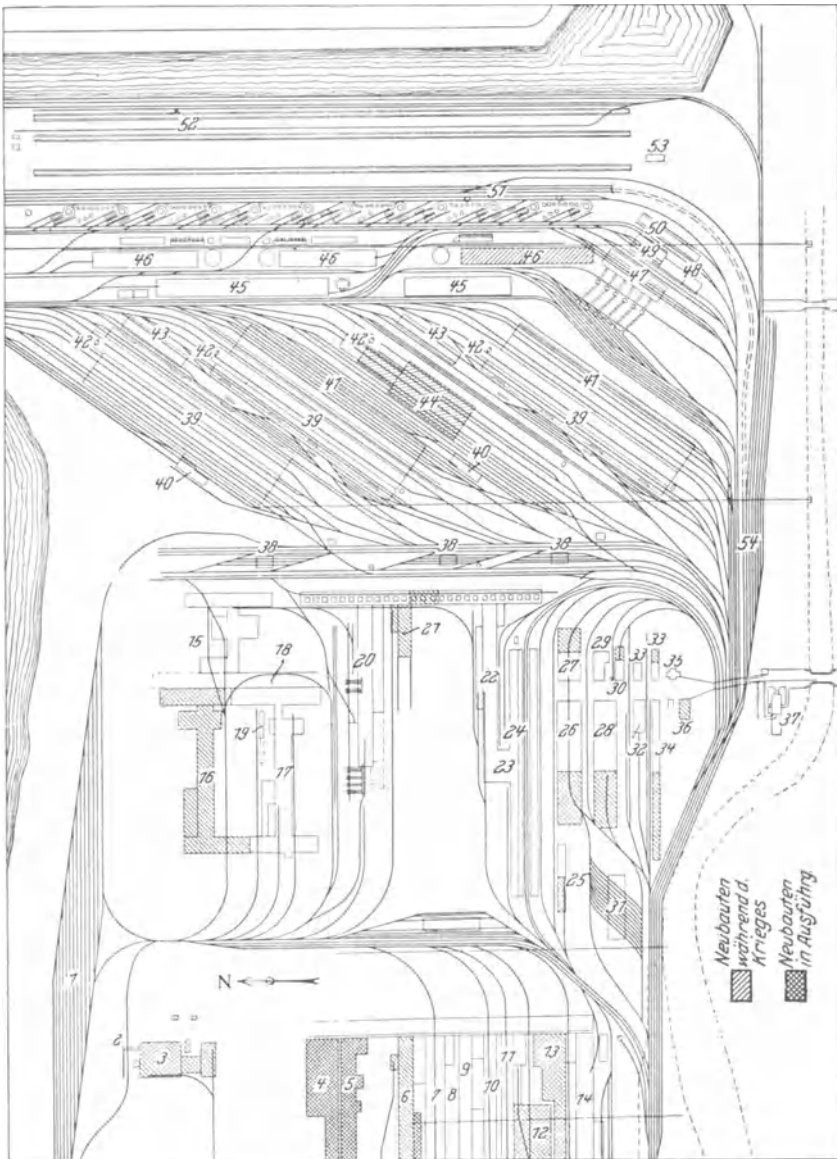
Grundriß des Garywerkes der Illinois Steel Co.
